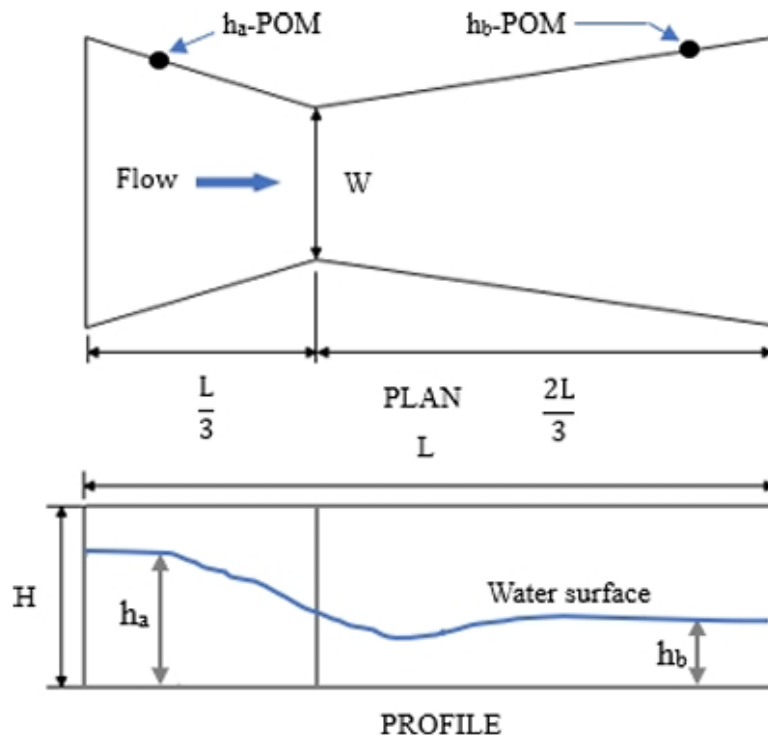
Vista plana y perfil del canal Cutthroat (Temeepattanapongsa, 2013).
